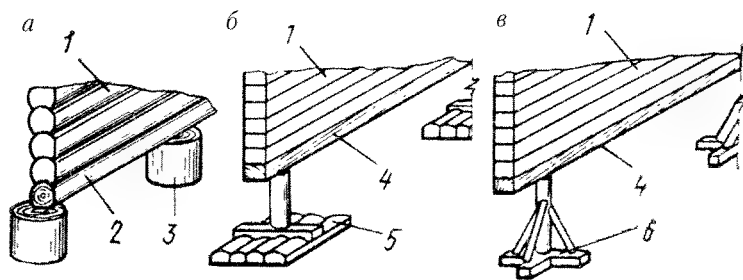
Конструктивные схемы столбчатых деревянных фундаментов:
